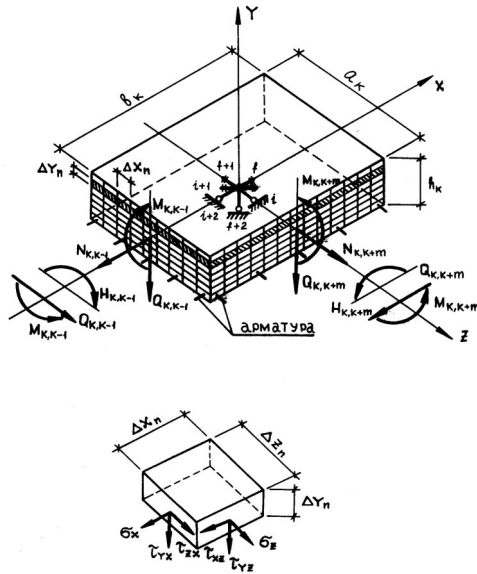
Расчетная схема по МСД для железобетонной плиты
